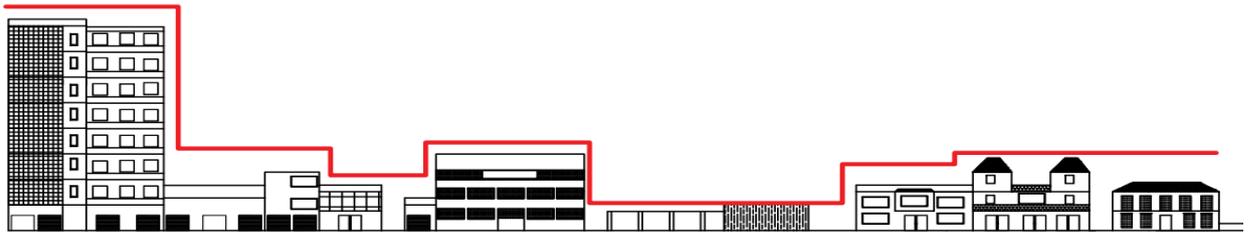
FAÇADE NORD AVANT L'INTERVENTION
